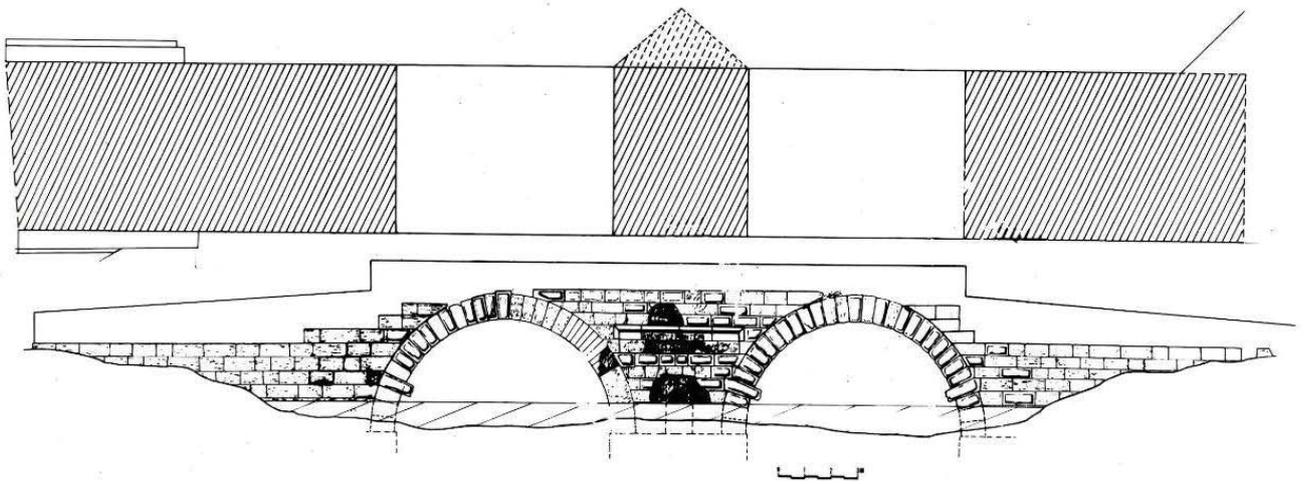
Dibujo del puente de Las Alcantarillas según P. Sillières.
